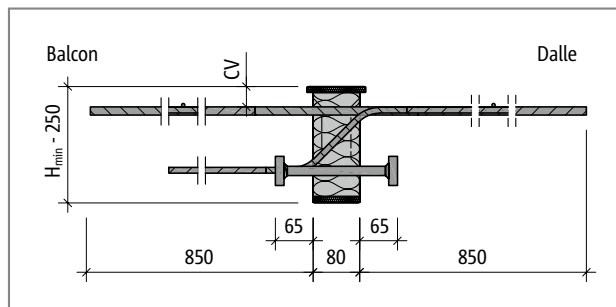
Schöck Isokorb® T Type K-M12 : Coupe du produit
